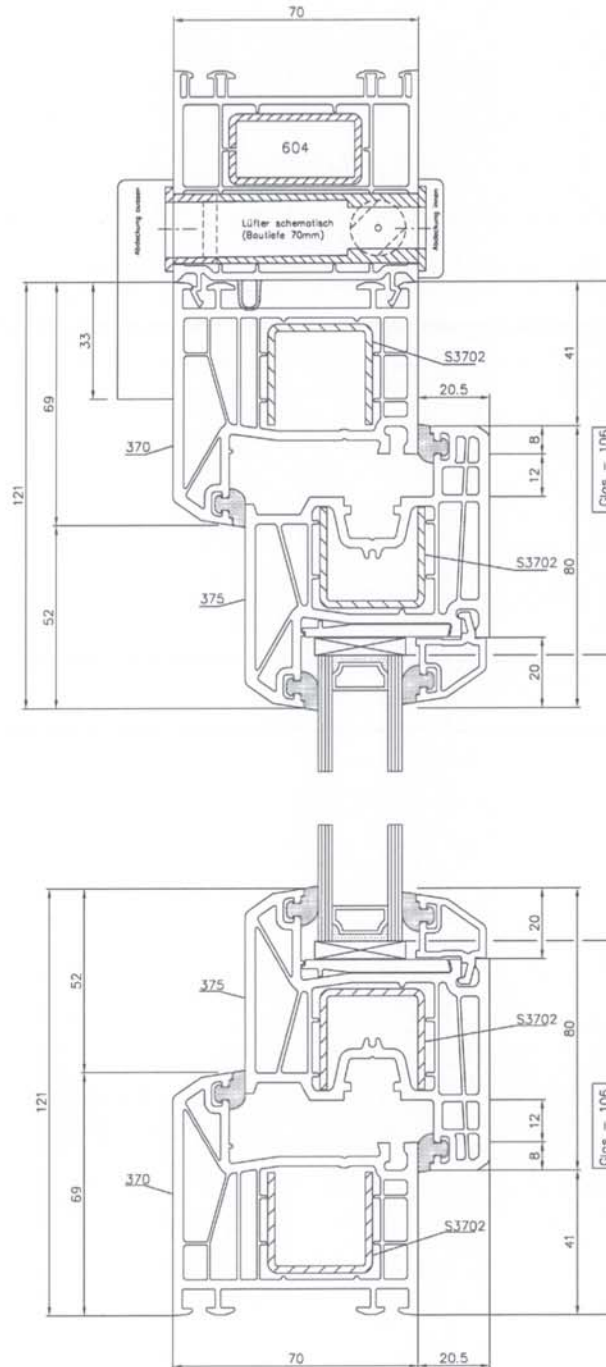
Einbaulage AirTronic im Fenster (Variante 70 mm)
